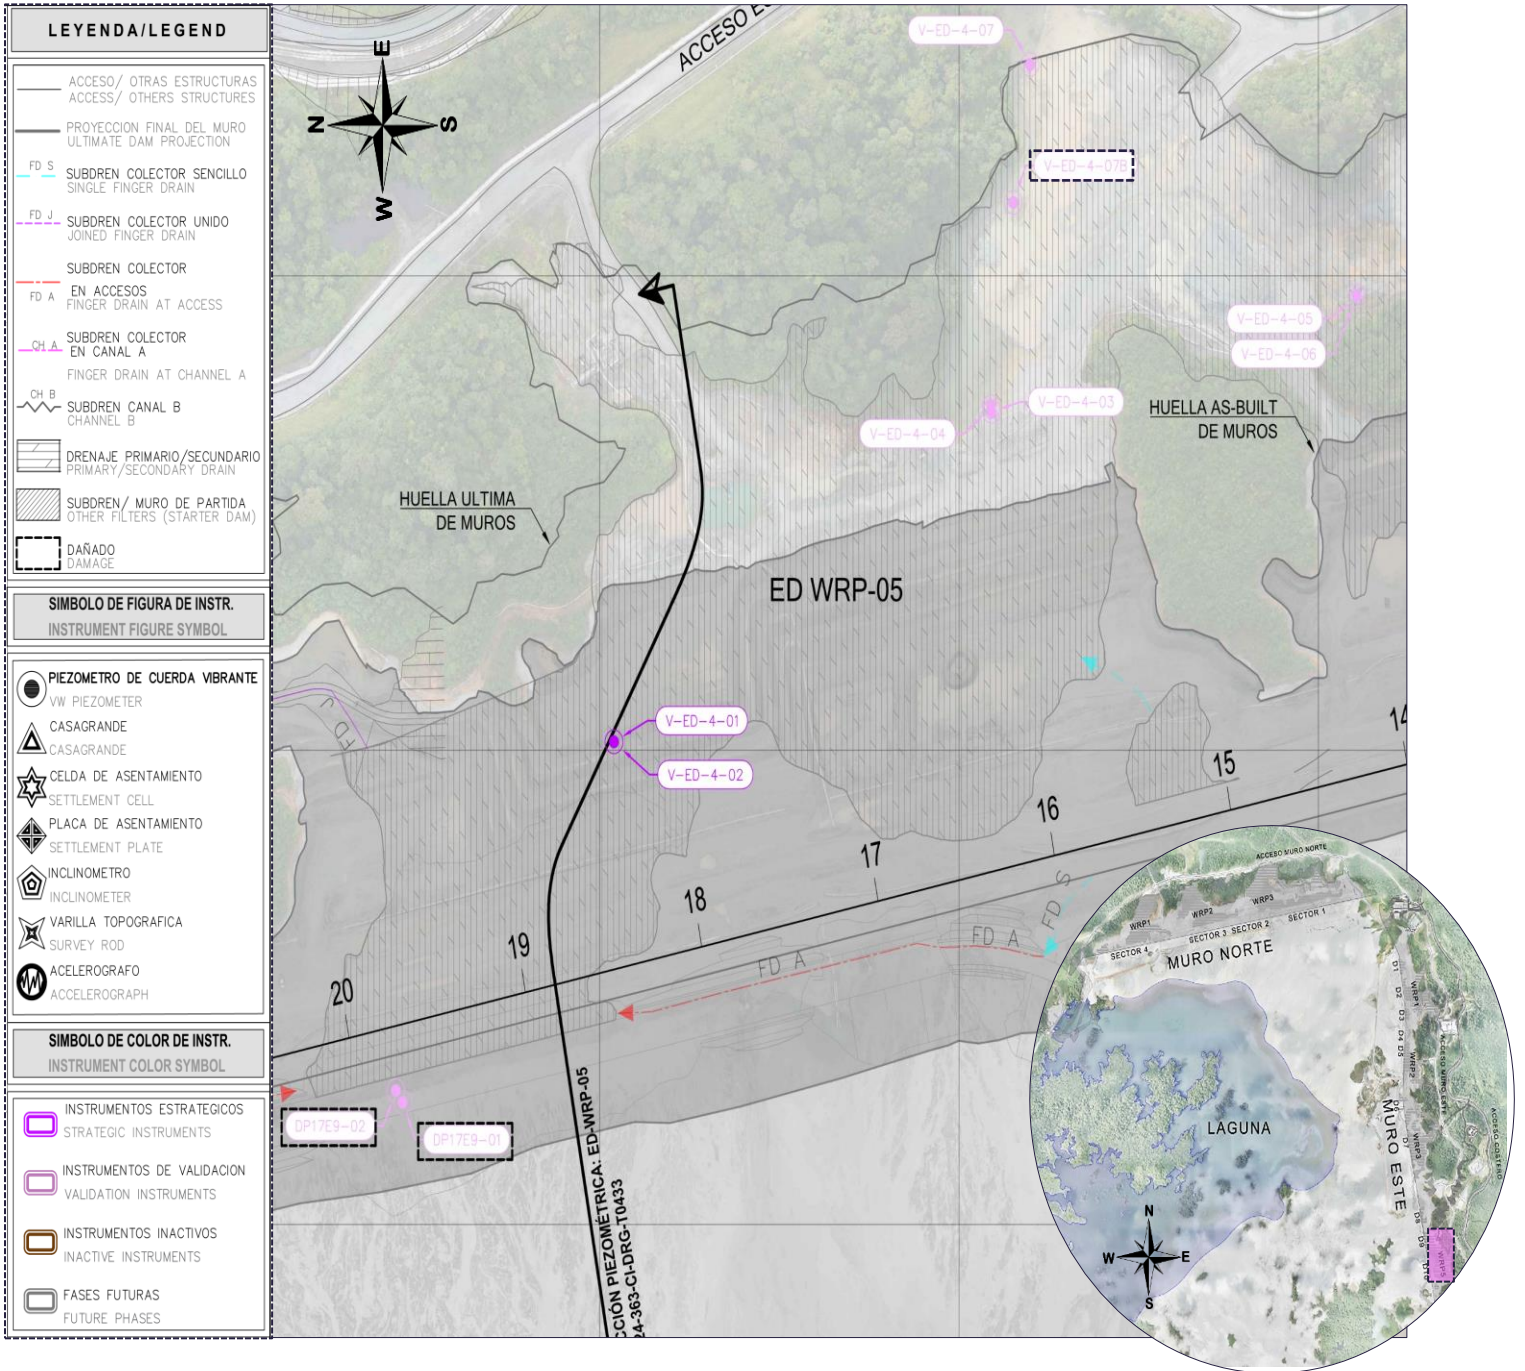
Vista de Planta en el Muro Este WRP5 con Piezómetros
